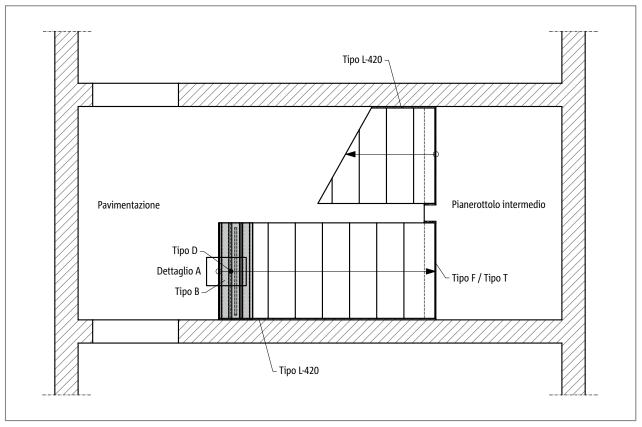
Schöck Tronsole  $^{\circ}$  tipo B + tipo D: disposizione dell'elemento nella pianta
